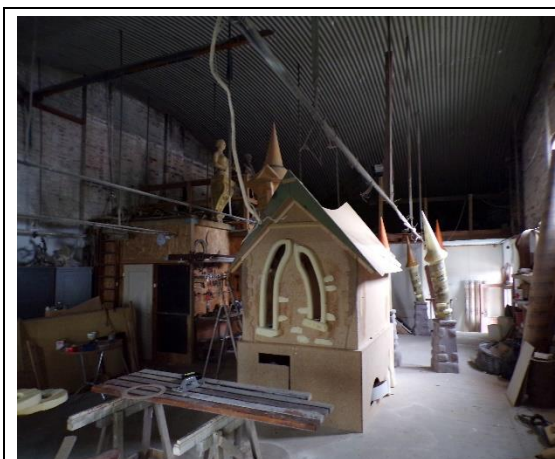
Obiekt E – Konstrukcja ścian nośnych
